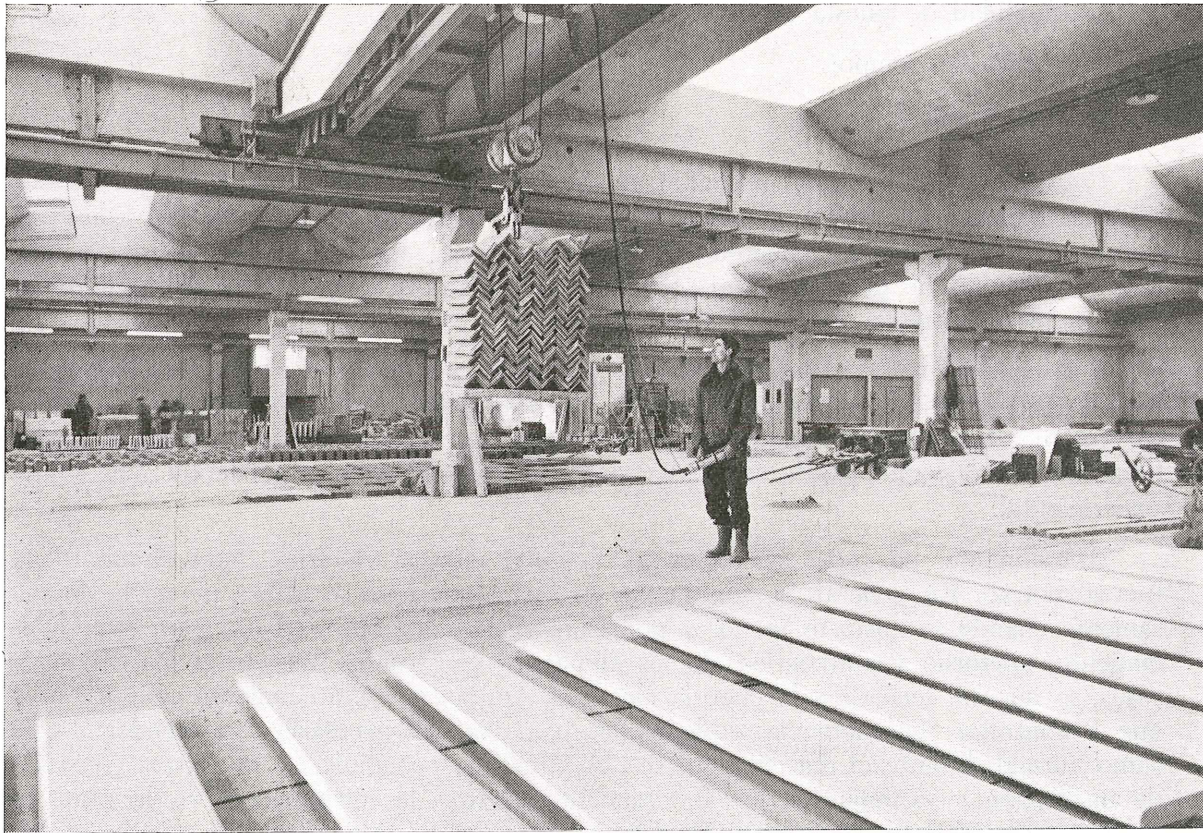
En esta empresa, dedicada a la fabricación de placas de hormigón, las piezas se colocan sobre el pavimento, calentado por electricidad, de una nave de grandes dimensiones. De esta forma, durante la noche, se consigue alcanzar un endurecimiento satisfactorio.
